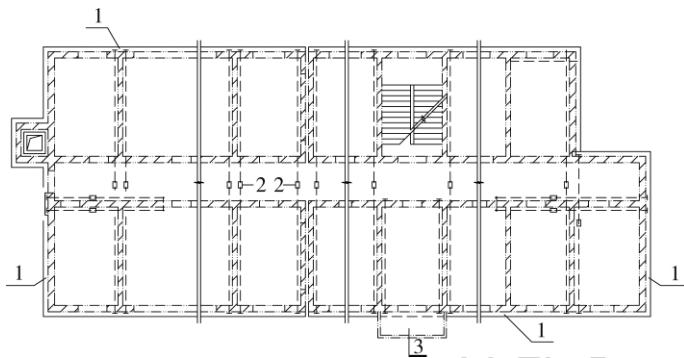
增设圈梁及钢拉杆平面示意图
